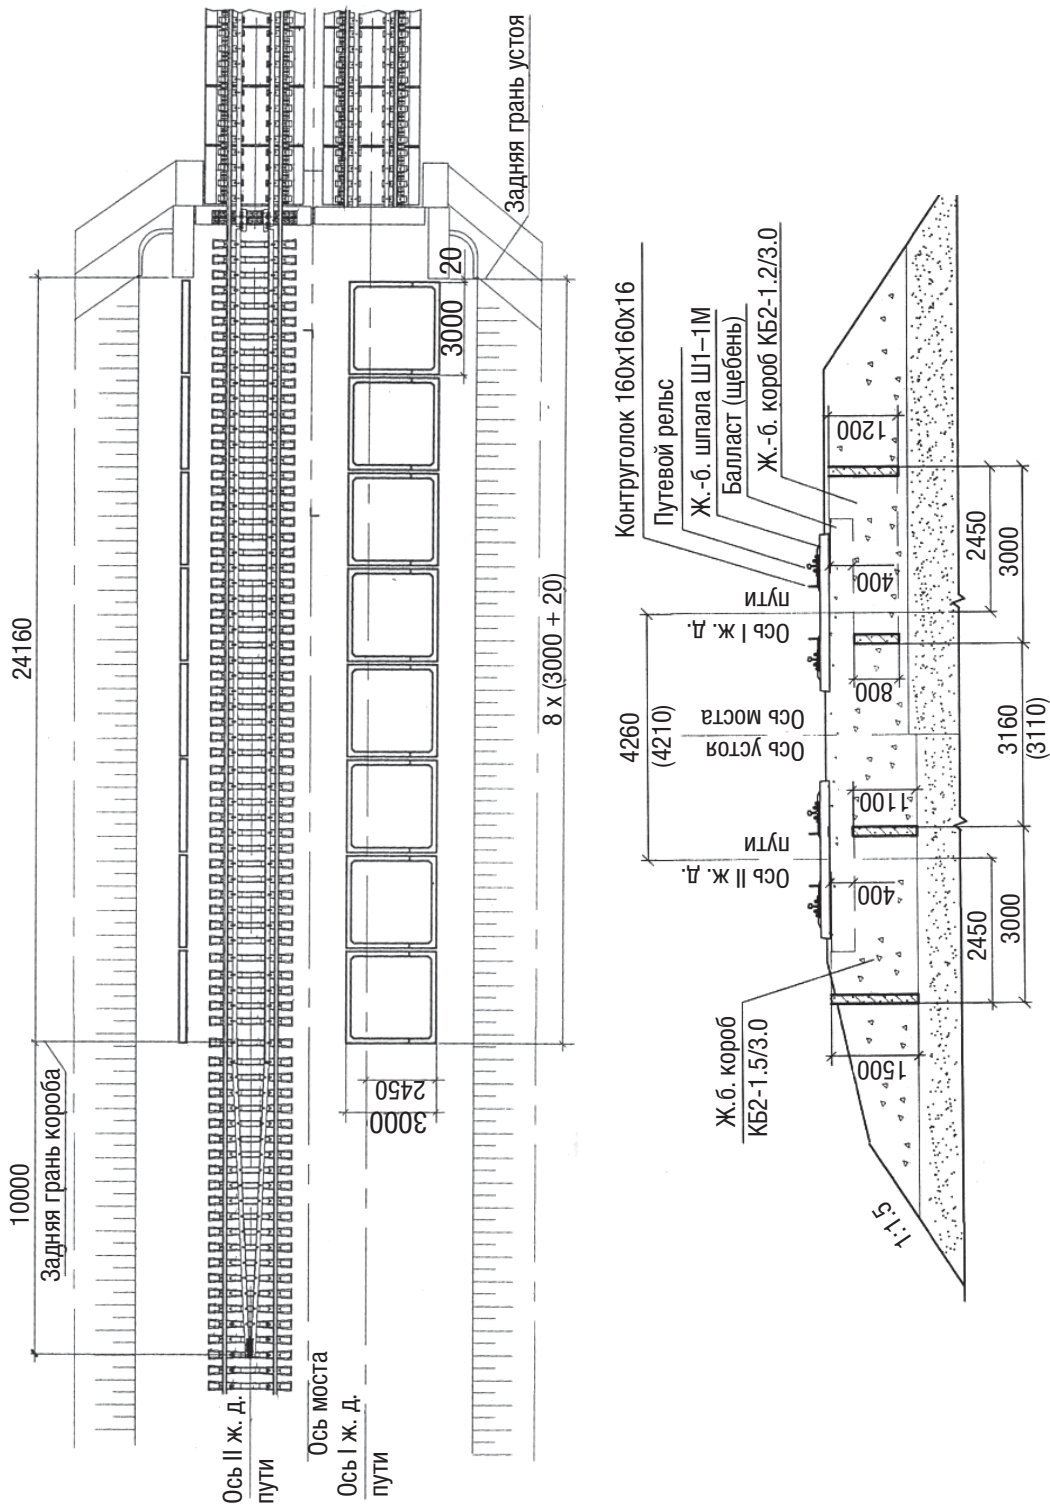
Конструкция переменной жесткости с применением бездонных железобетонных коробов [2]
